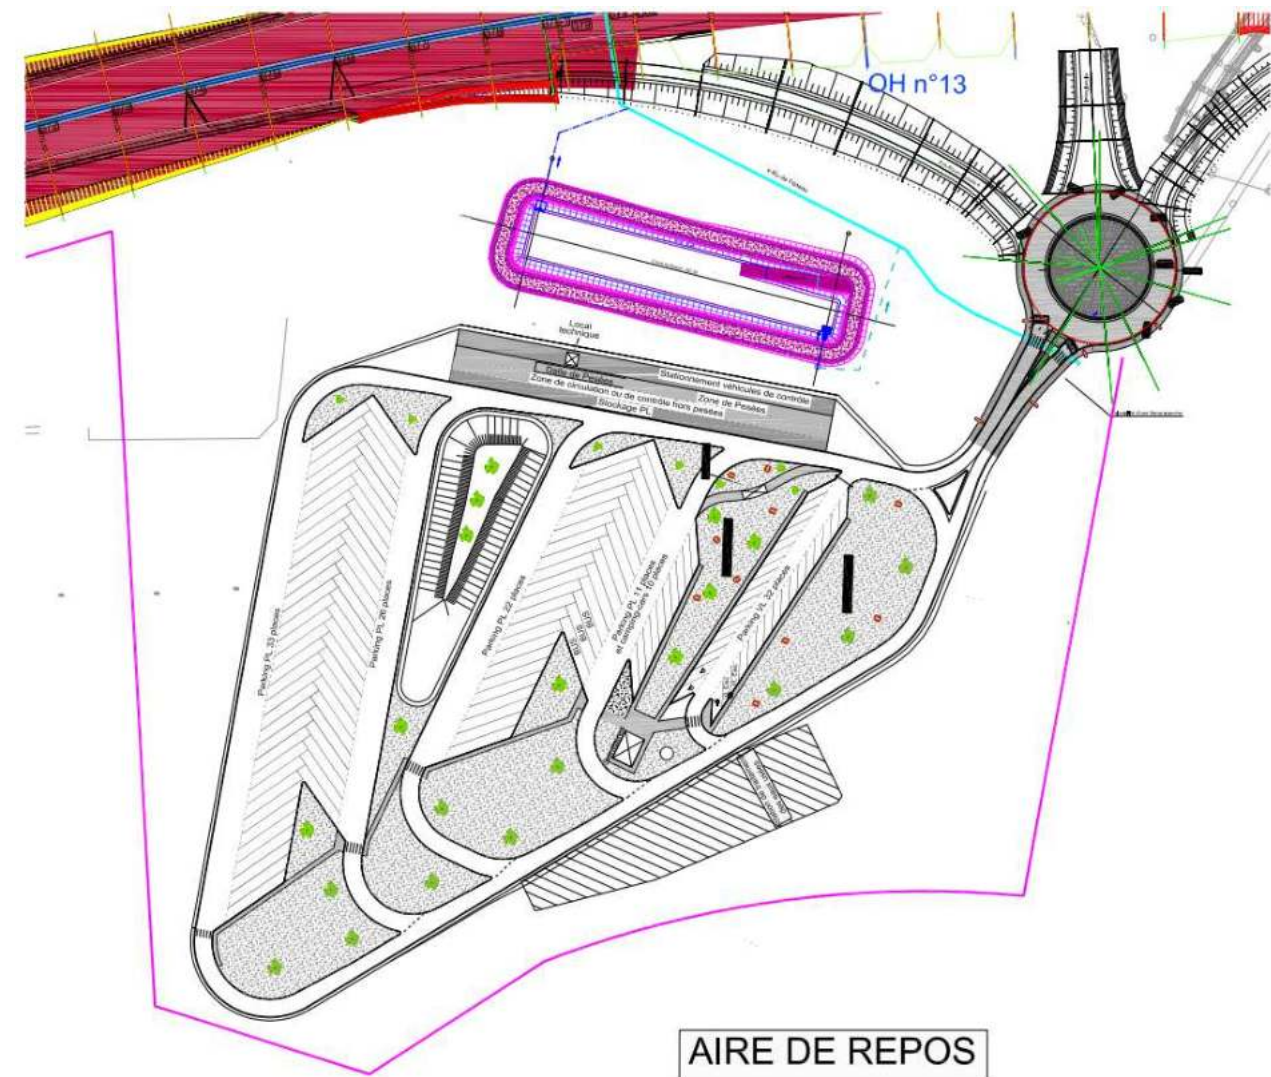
PLAN DE L'AIRE DE REPOS
